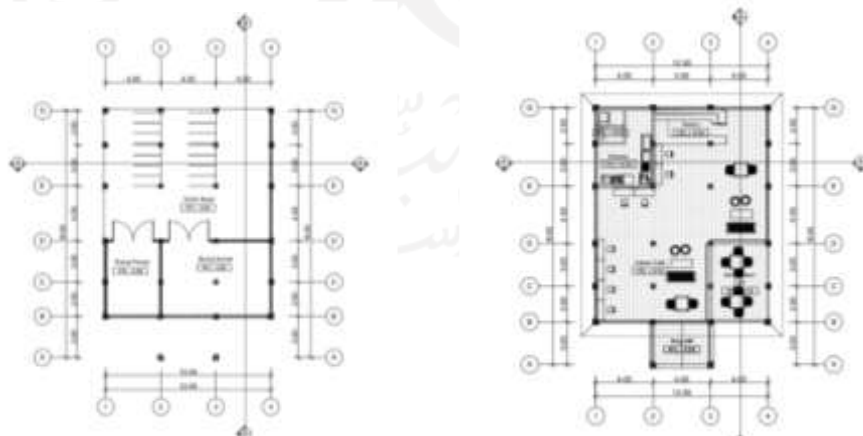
Denah Basement dan Lantai 1 Showroom
